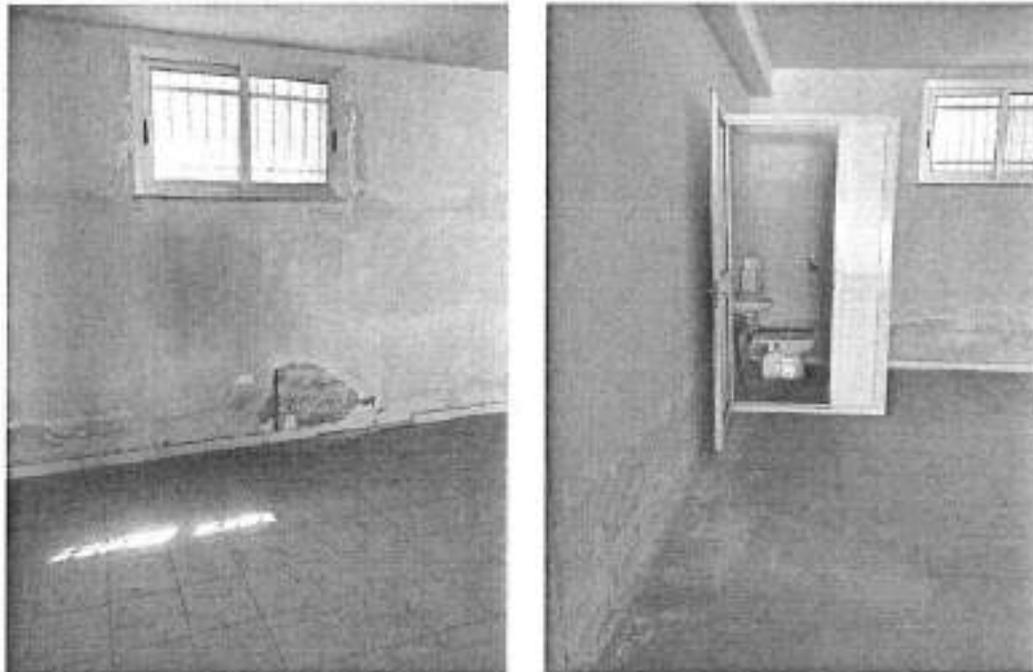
e 16 – DETTAGLIO IMMOBILI PIANO SEMINTERRATO SUB 59
